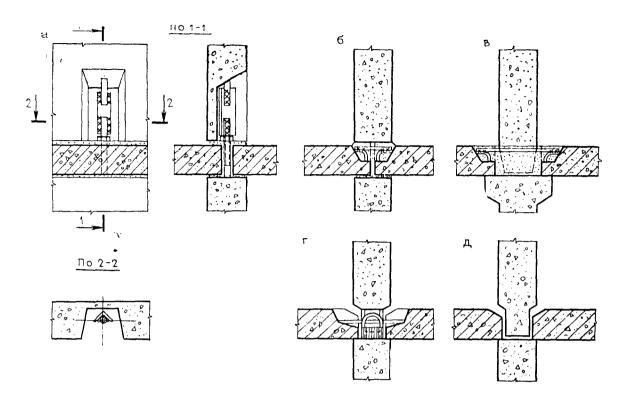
Стальные связи в горизонтальных стыках панелей внутренних стен с перекрытиями
